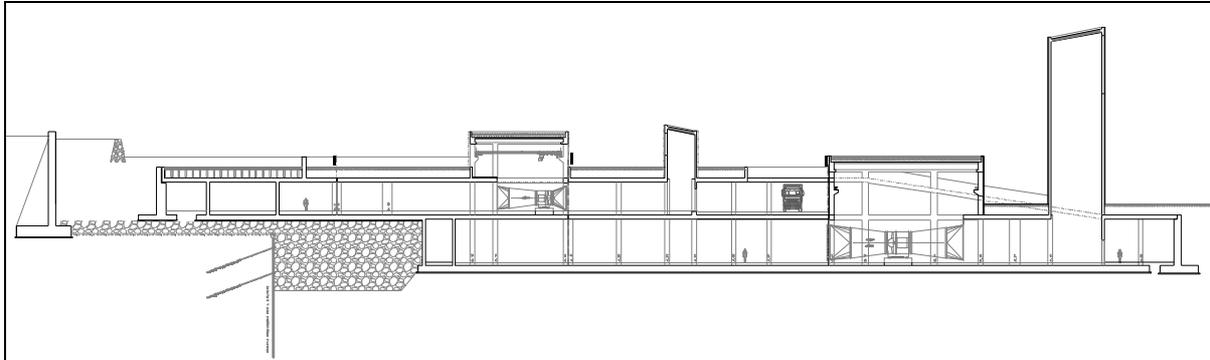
Centrale di Ventilazione di Maddalena – Sezione Longitudinale
